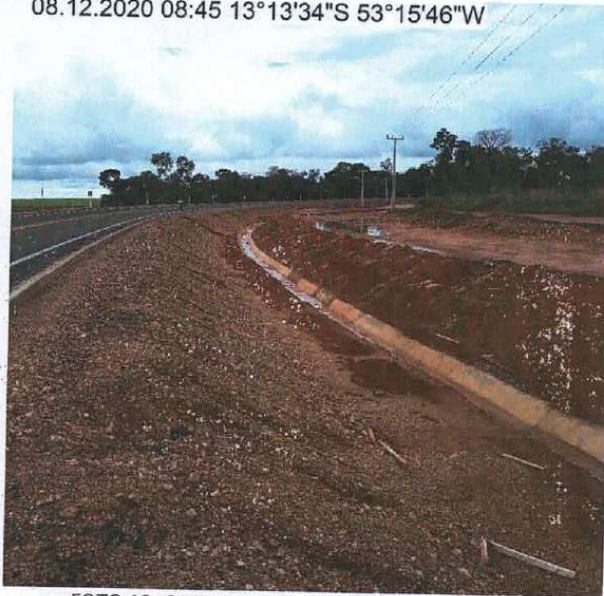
CANALETA DE CONCRETO IMPLANTADA
